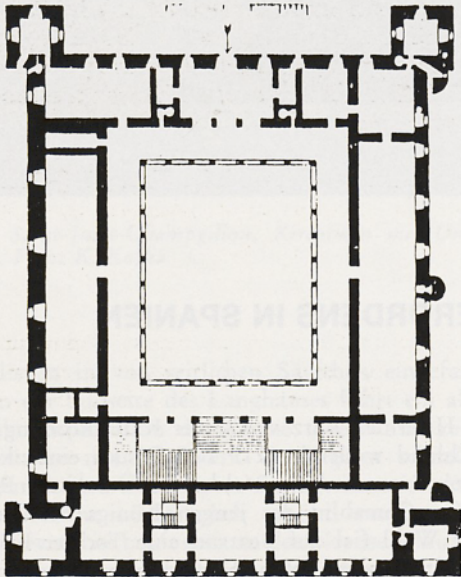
Grundriß des Alcázar in Toledo (oben = Norden). Erste Anlage um 800, im 11. Jh. erweitert, damals jedenfalls Geviertbau mit etwas vorspringenden Türmen. Die späteren Umbauten und Ergänzungen betrafen nie die Fundamente
